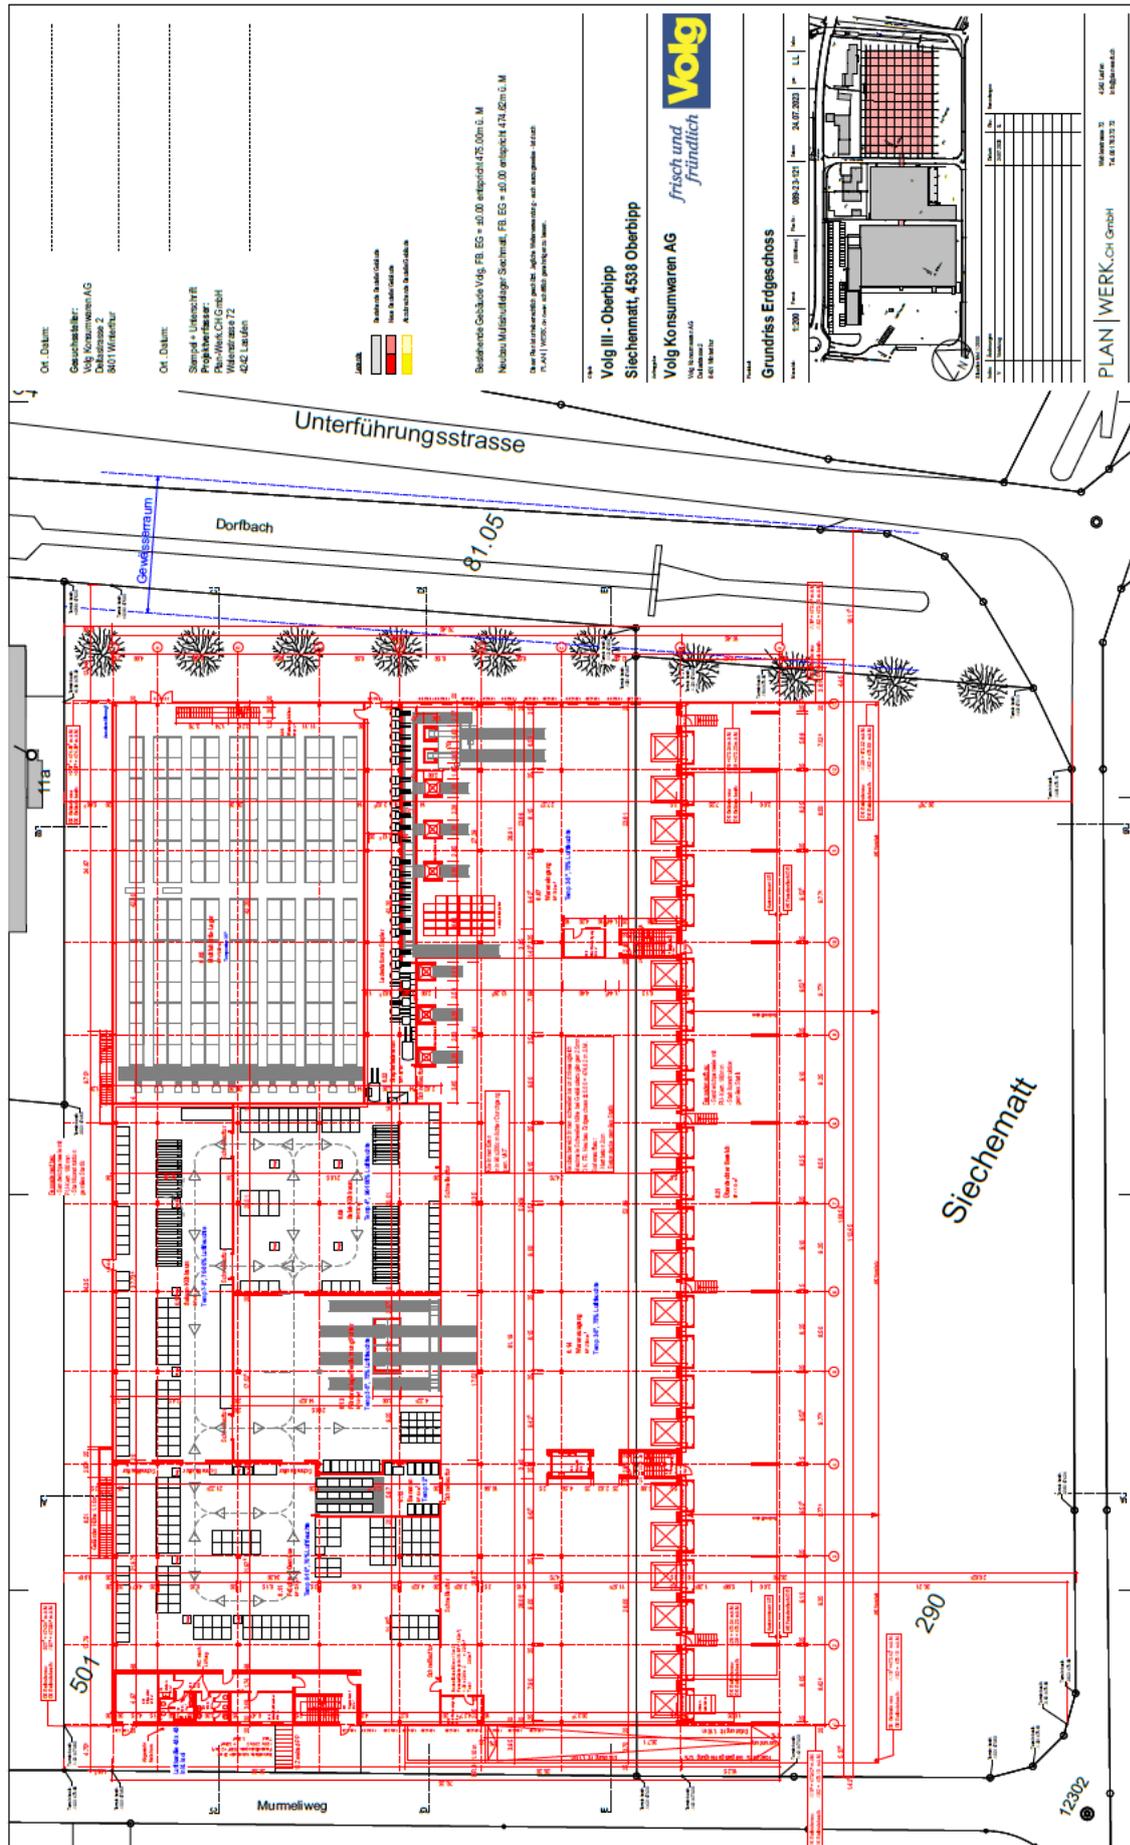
Grundriss Erdgeschoss (Stand 24.07.2023)
